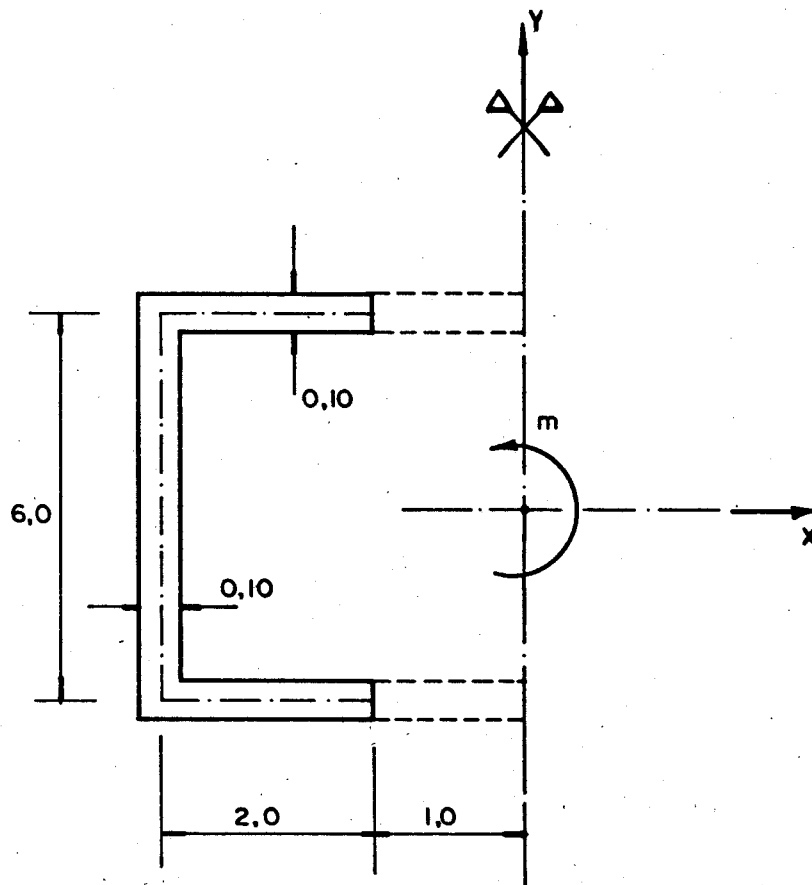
PLANTA DA ESTRUTURA EXEMPLO
